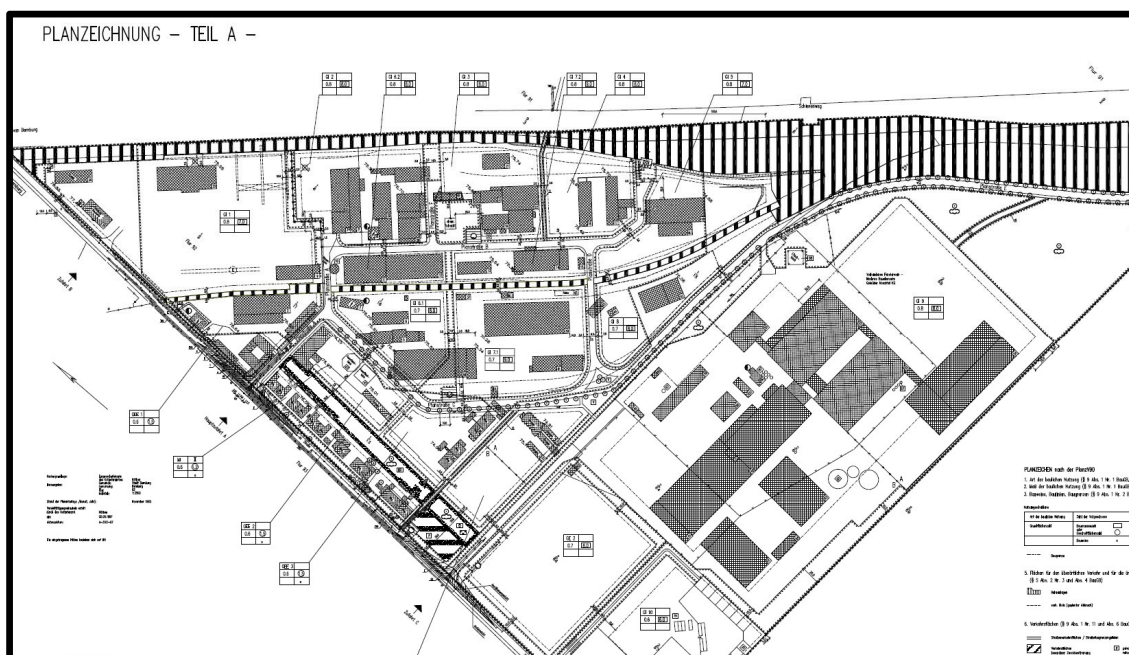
Ausschnitt Bebauungsplan Baalberge Nr 5/94
